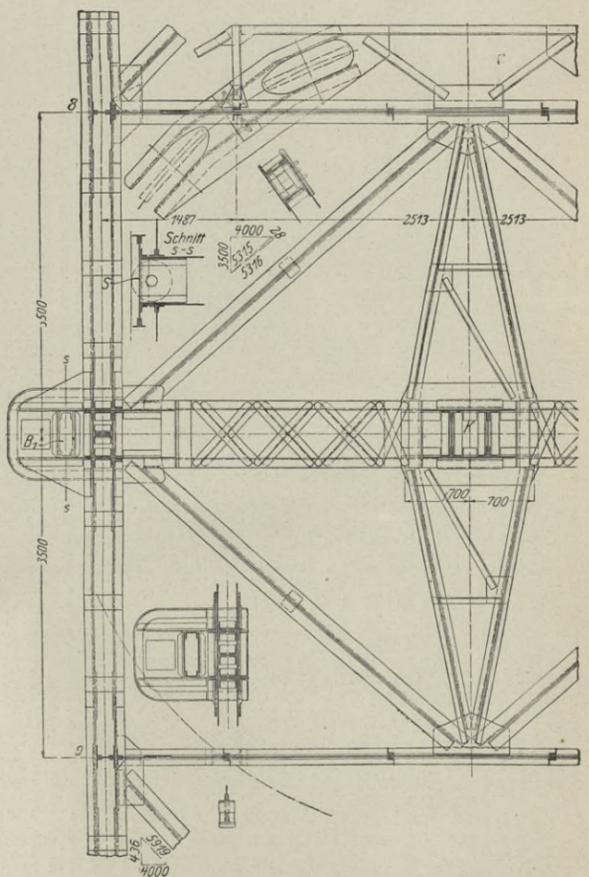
Grundriß über dem Drehpfeiler. (1:75)
